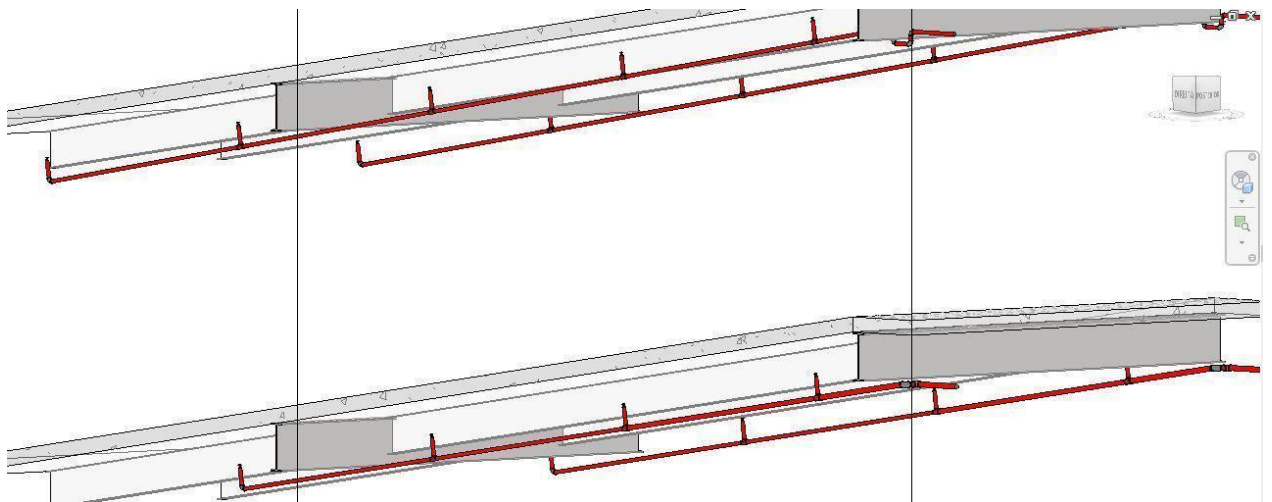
Tubulação de ligação entre o 4° e 5° pavimento
